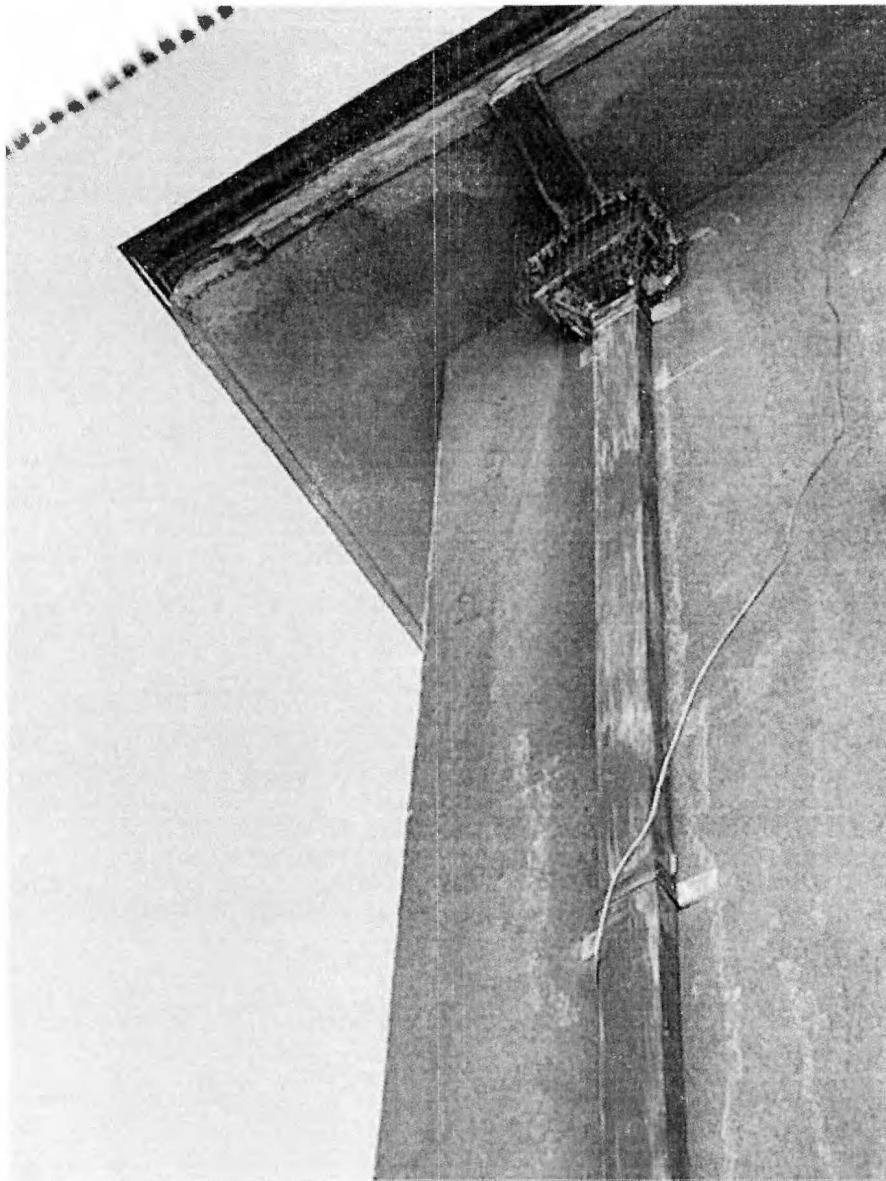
Fisuramiento y desprendimiento de estucos en alero de techo en fachada este.
